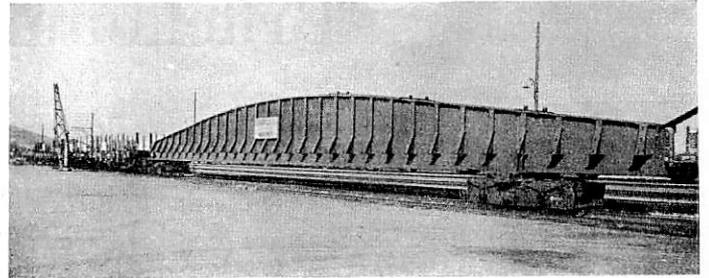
Sonderdrehgestelle mit 32 m langen Brückenträgern.
